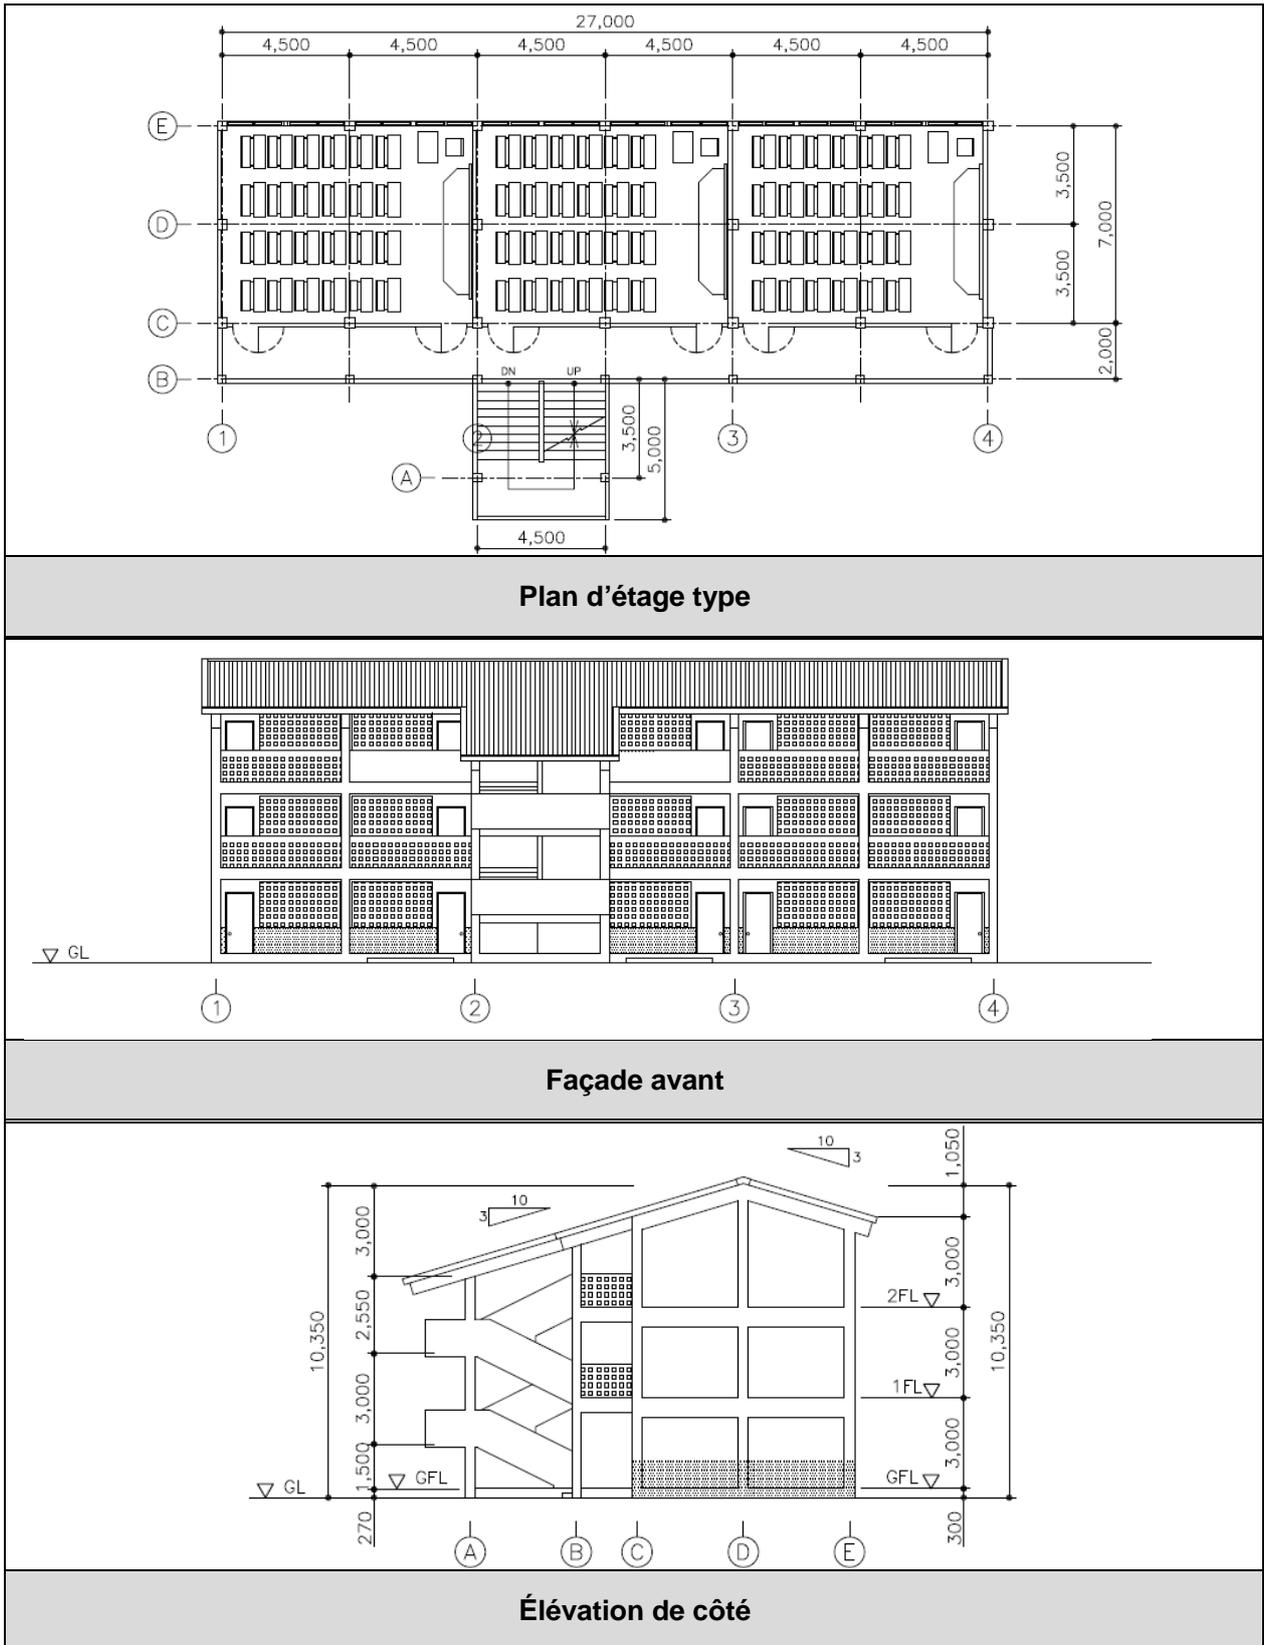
Plan type - Bloc de salles de classe du type B (3 SDC x 3 niveaux)
